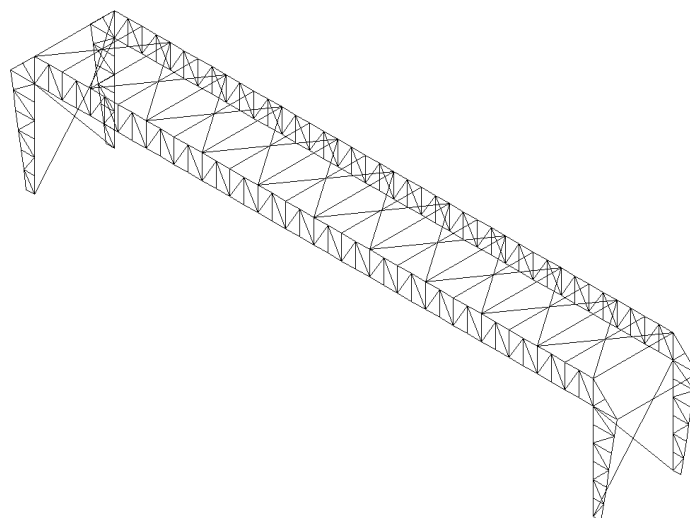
Montagem do contraventamento no plano da cobertura e remoção dos estais
